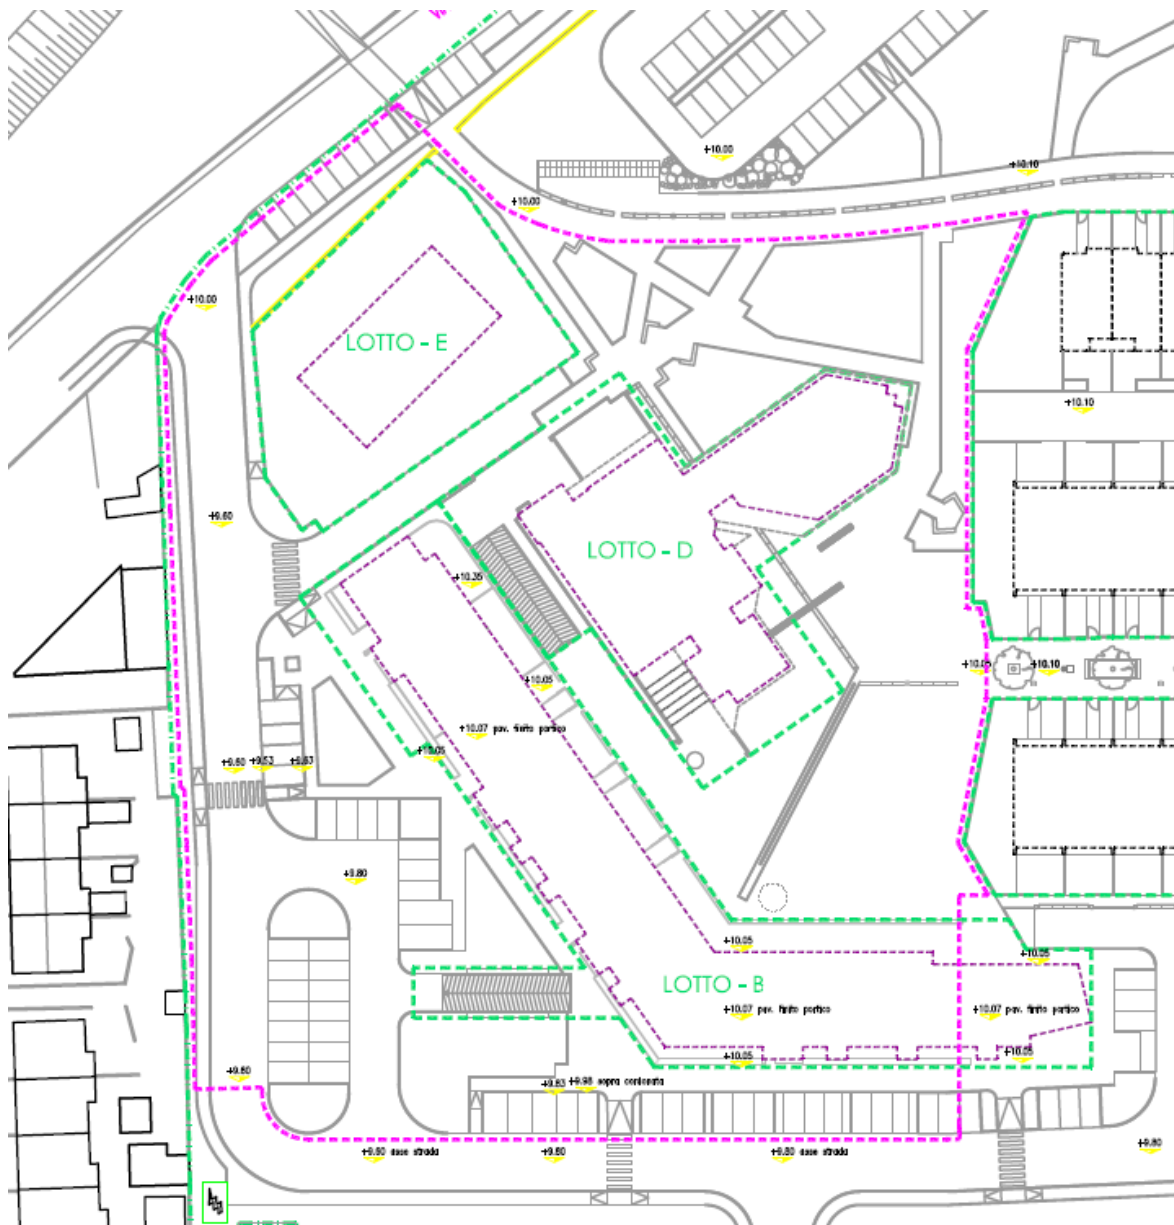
Estratto della planimetria con l'ambito di intervento (linea viola).
